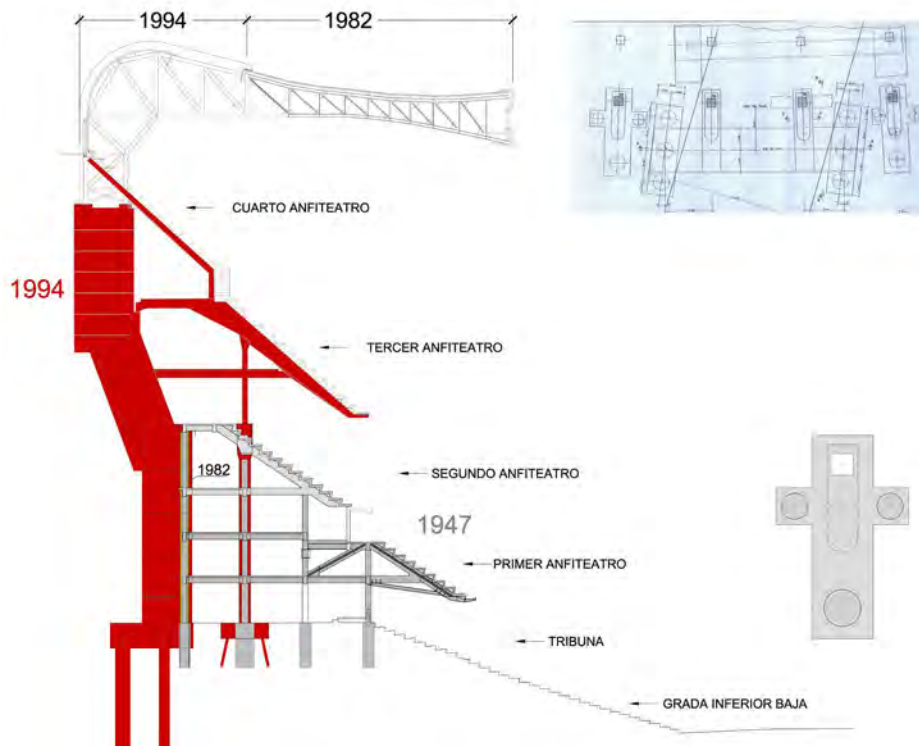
Sección transversal oeste y fondos tras la ampliación de 1994, planta de cimentación de una costilla típica (der. abajo) y refuerzo de las estructuras puente sobre el túnel en el lado sur (der. arriba).
